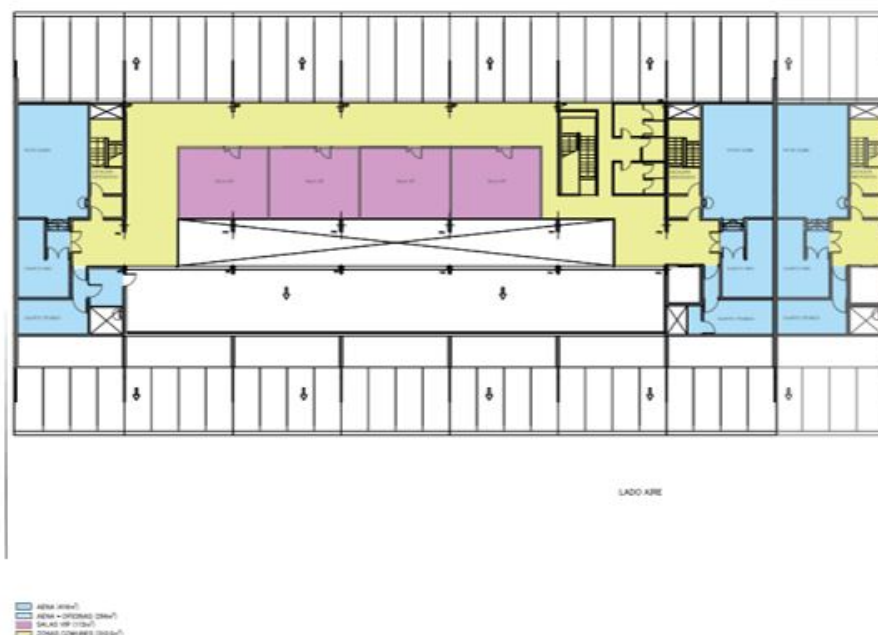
Vista en Planta de los Espacios de la Planta Superior Proyectada
